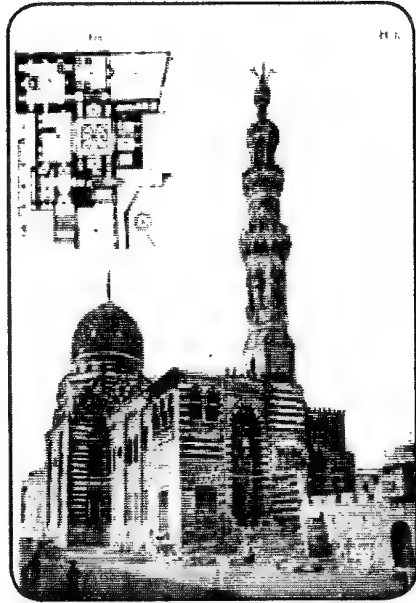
خانقاه الأشرف اينال - مسقط أفقي
